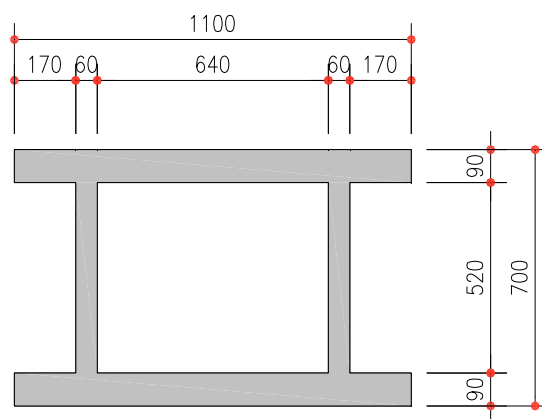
Stralcio Prospetto Travi di Sostegno
